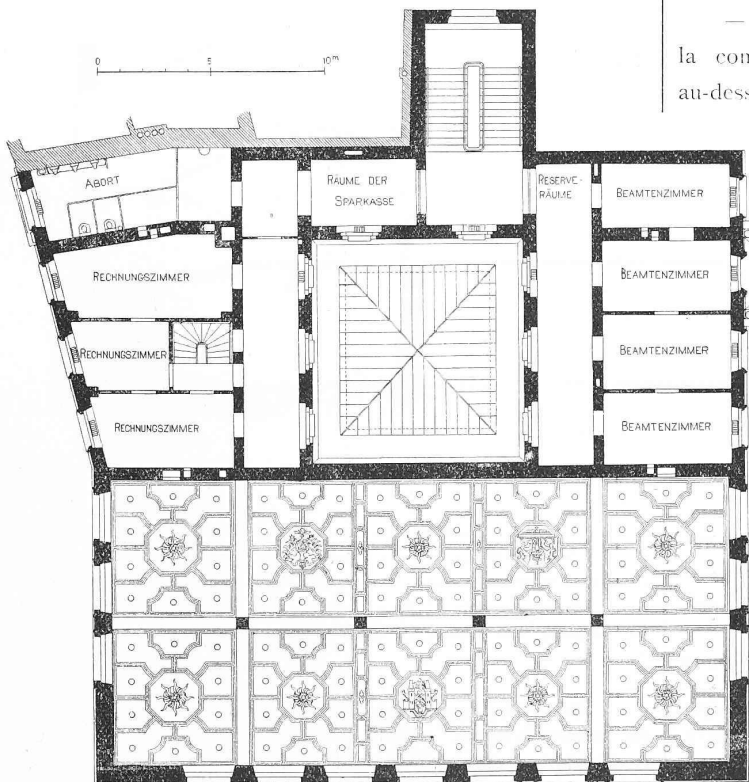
Grundriss vom II. Obergeschoss mit der Decke des Kassensaales. — 1 : 300.
